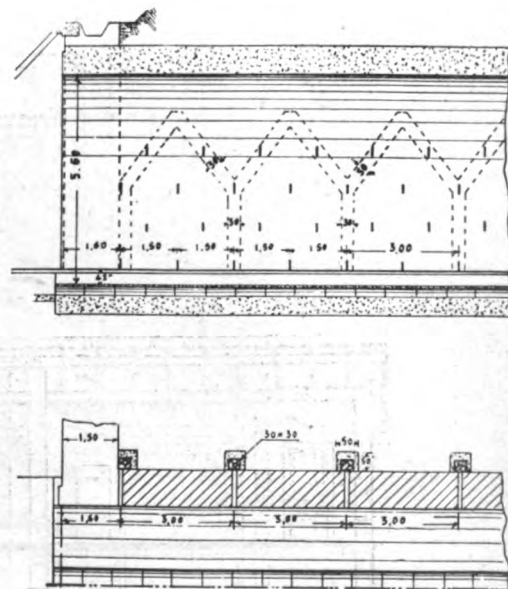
Disposizione dei drenaggi per gallerie in terreni eminentemente acquitrinosi.
